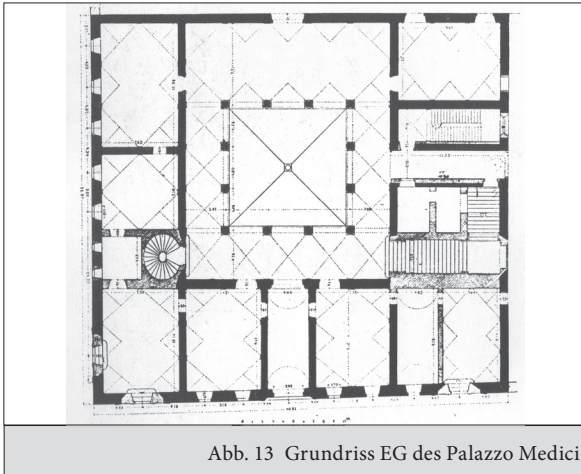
Grundriss EG des Palazzo Medici
